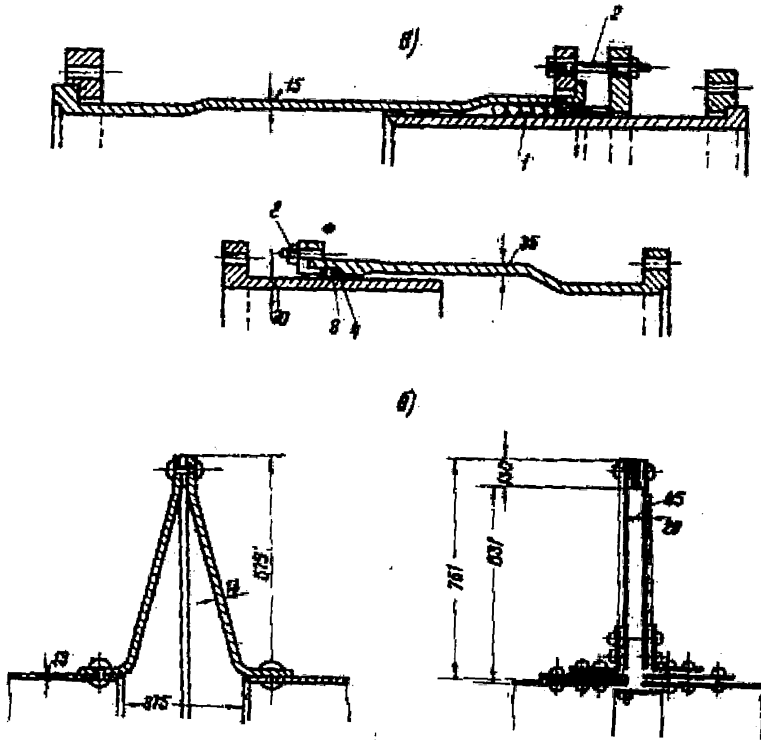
Компенсаторы (а - сальниковые; б - тарельчатые): 1 - пенка с резиновым ядром; 2 - болт; 3 - кожа; 4 - бронза
